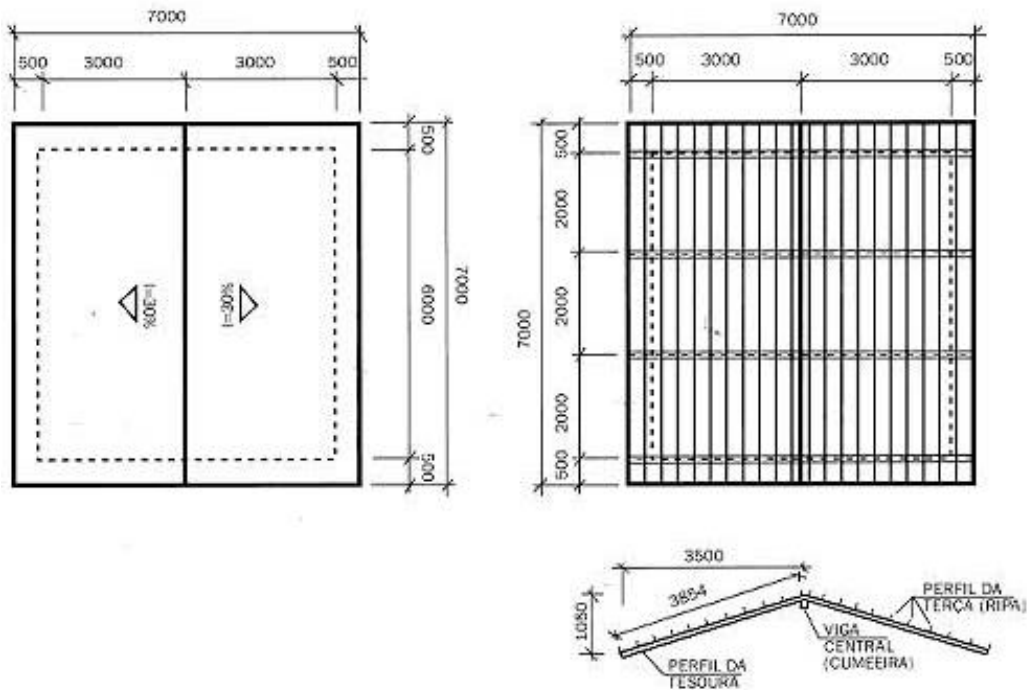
Planta de cobertura e engradamento metálico do telhado tipo colonial, sistema Usiteto.
